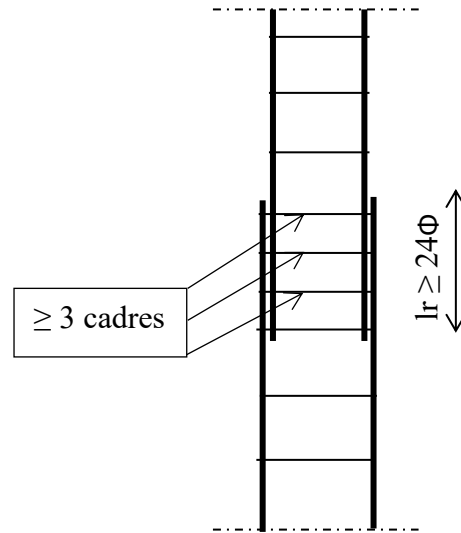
Armatures transversales dans la zone de recouvrement
